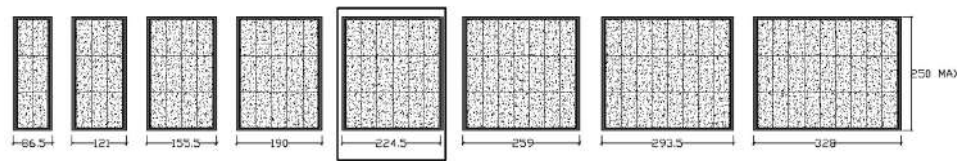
Dimensions des parois prédéfinies par la société PailleTech (PailleTech (2016))
